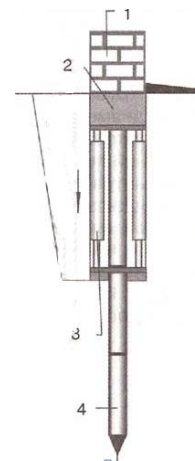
Схема посилення фундаменту з-під стіни:
